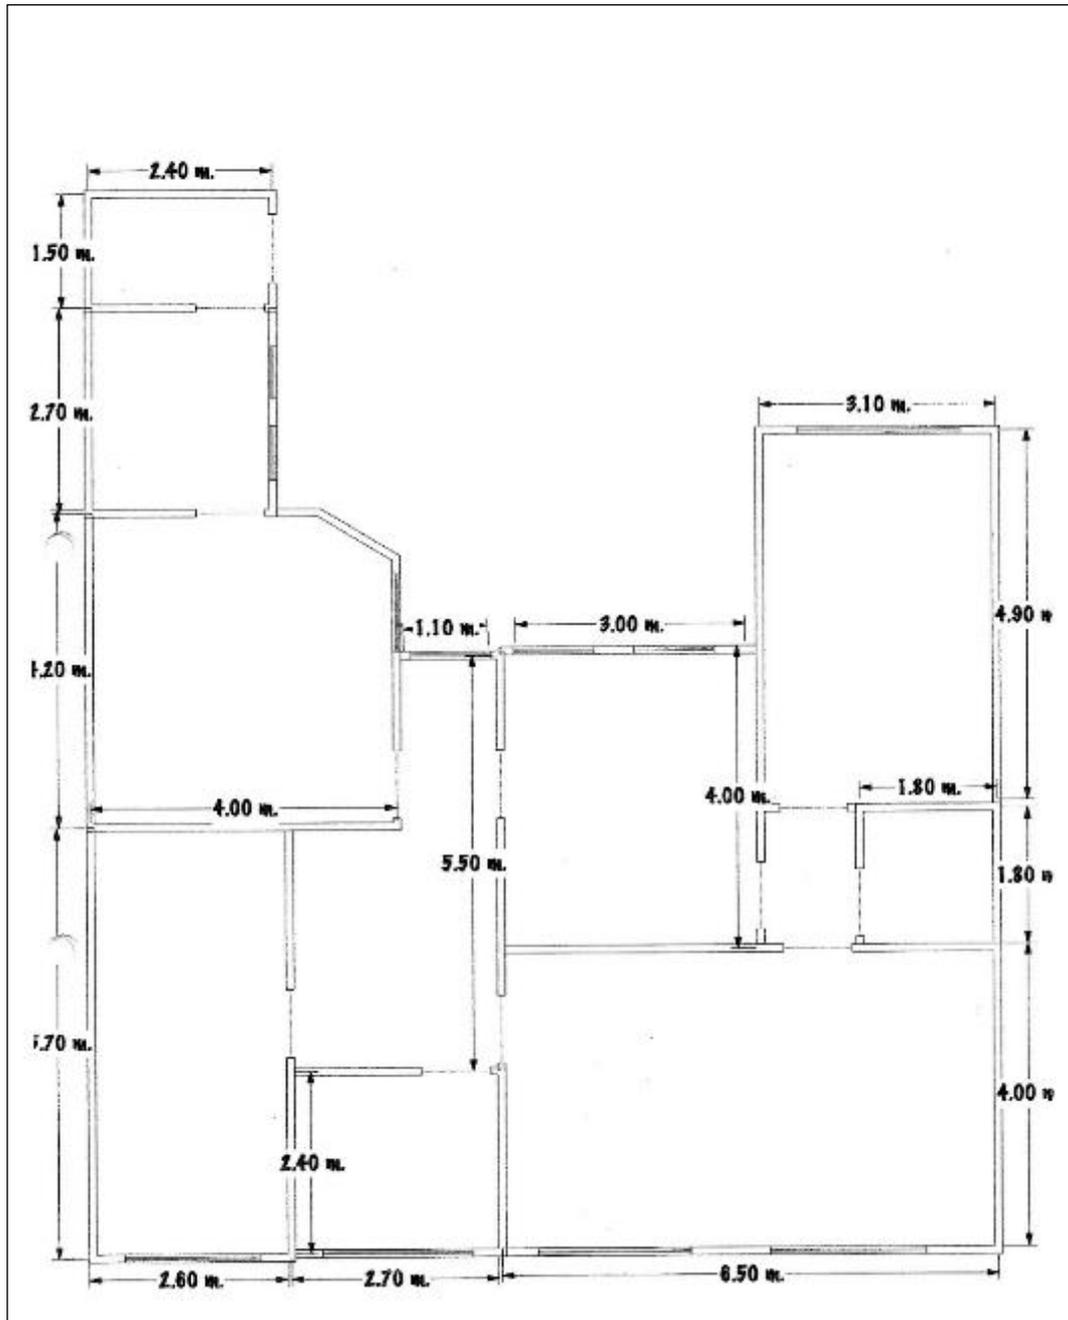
Grundriss-skizze Obergeschoss (Quelle Eigentümer)
